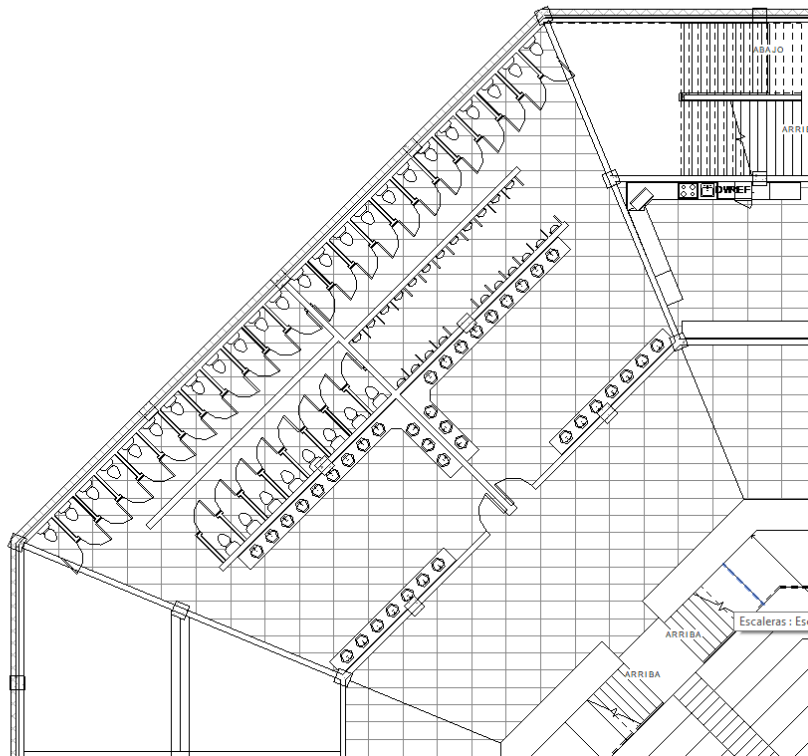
Vista en planta del sector sur. Fuente: elaboración propia.
